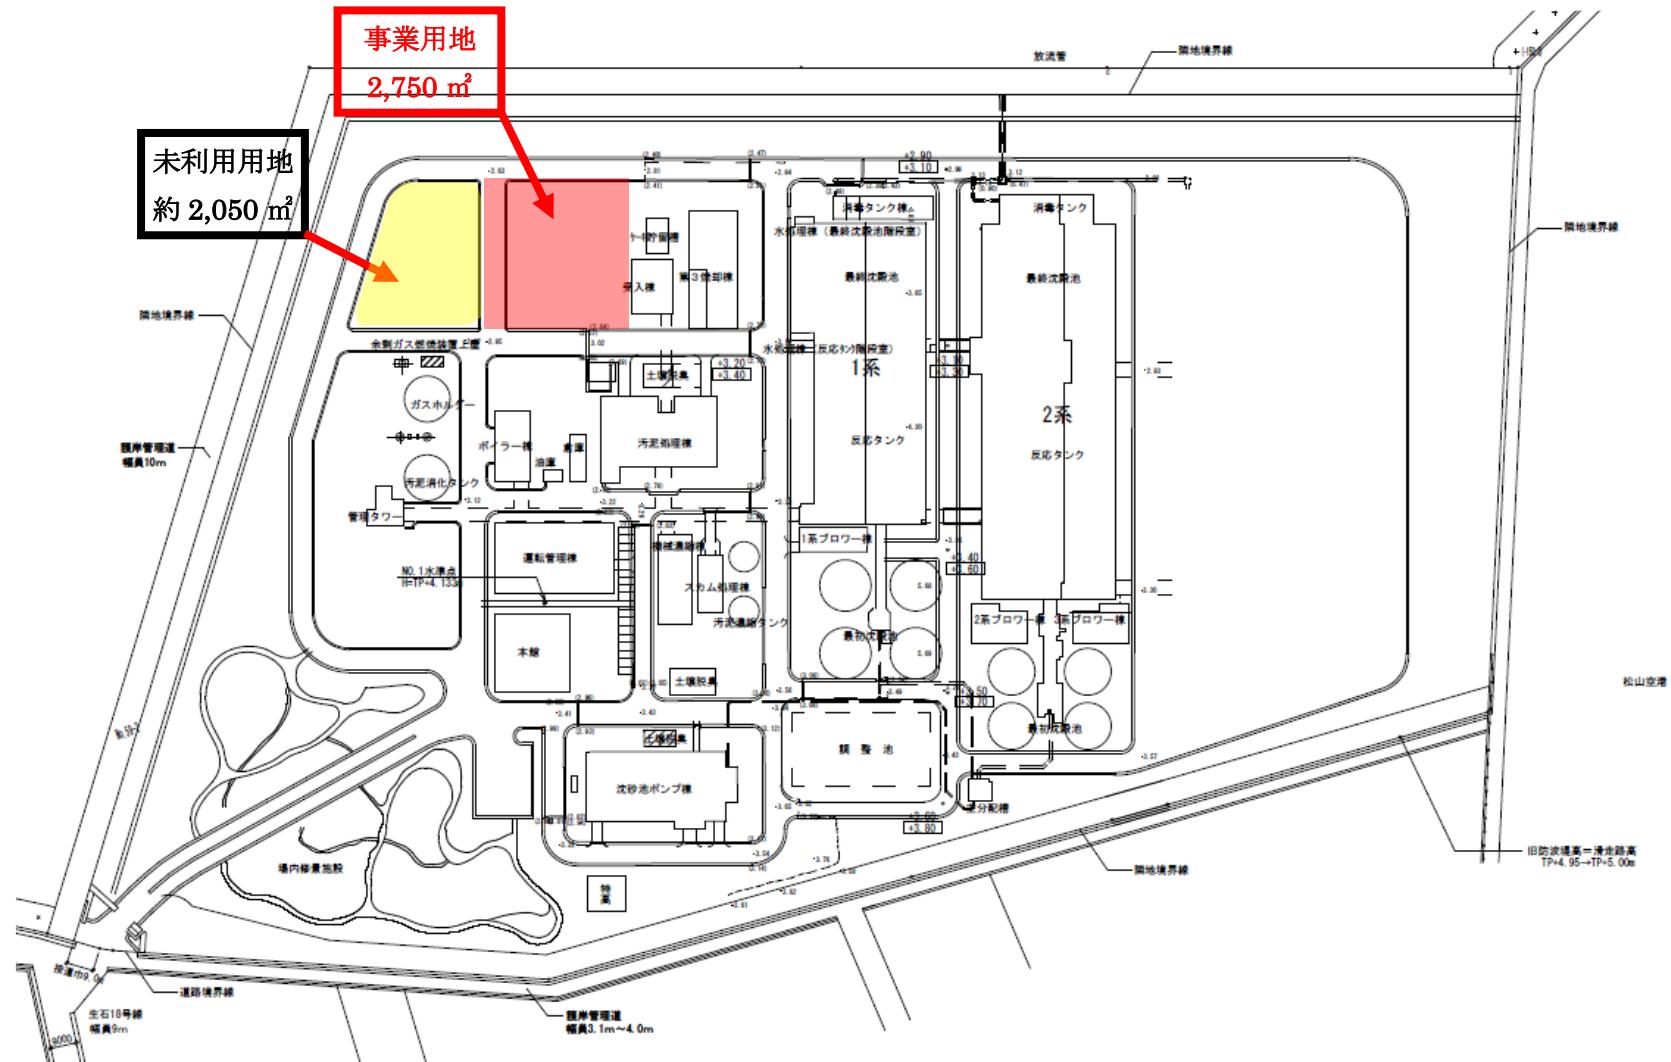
西部浄化センターの一般平面図及び事業用地等位置図
